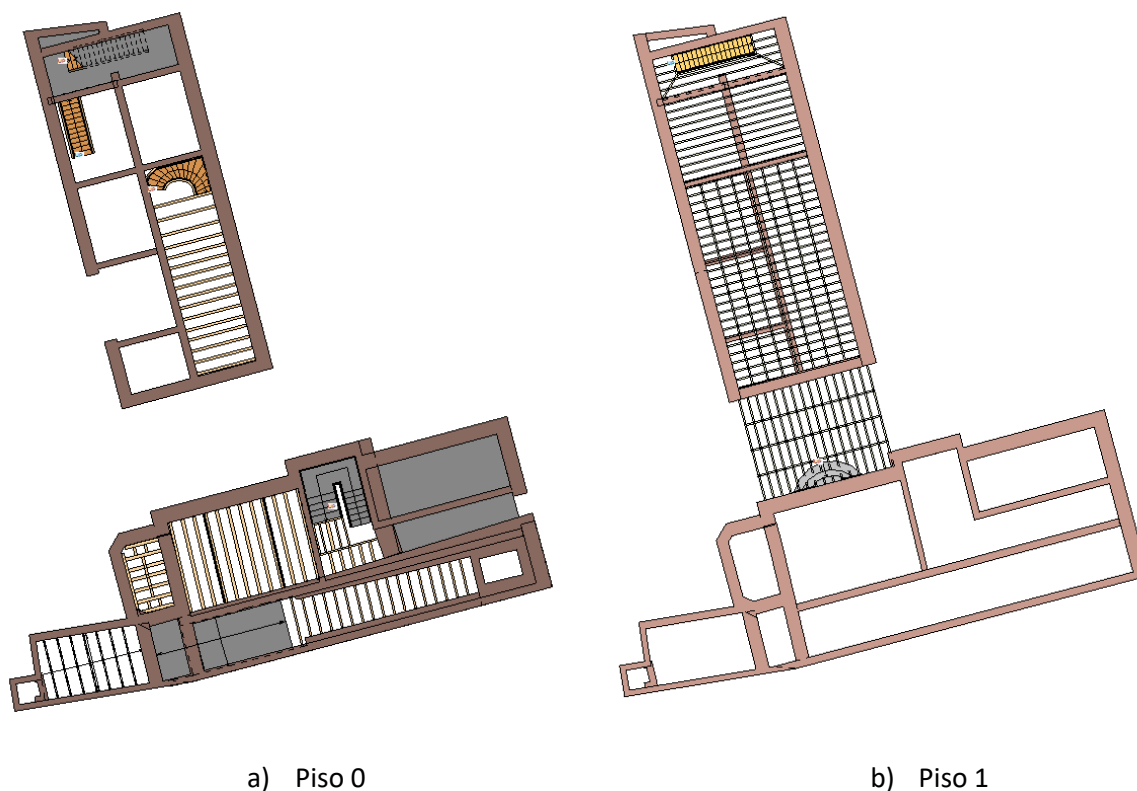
Plantas estruturais do Edifício unifamiliar no Revit.
